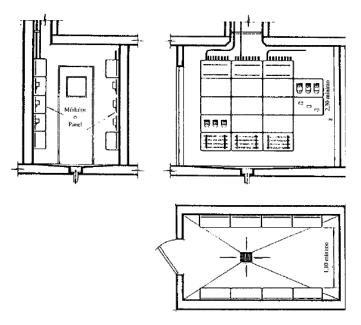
Alzado, planta y perfil de un local de contadores eléctricos centralizados [13].
